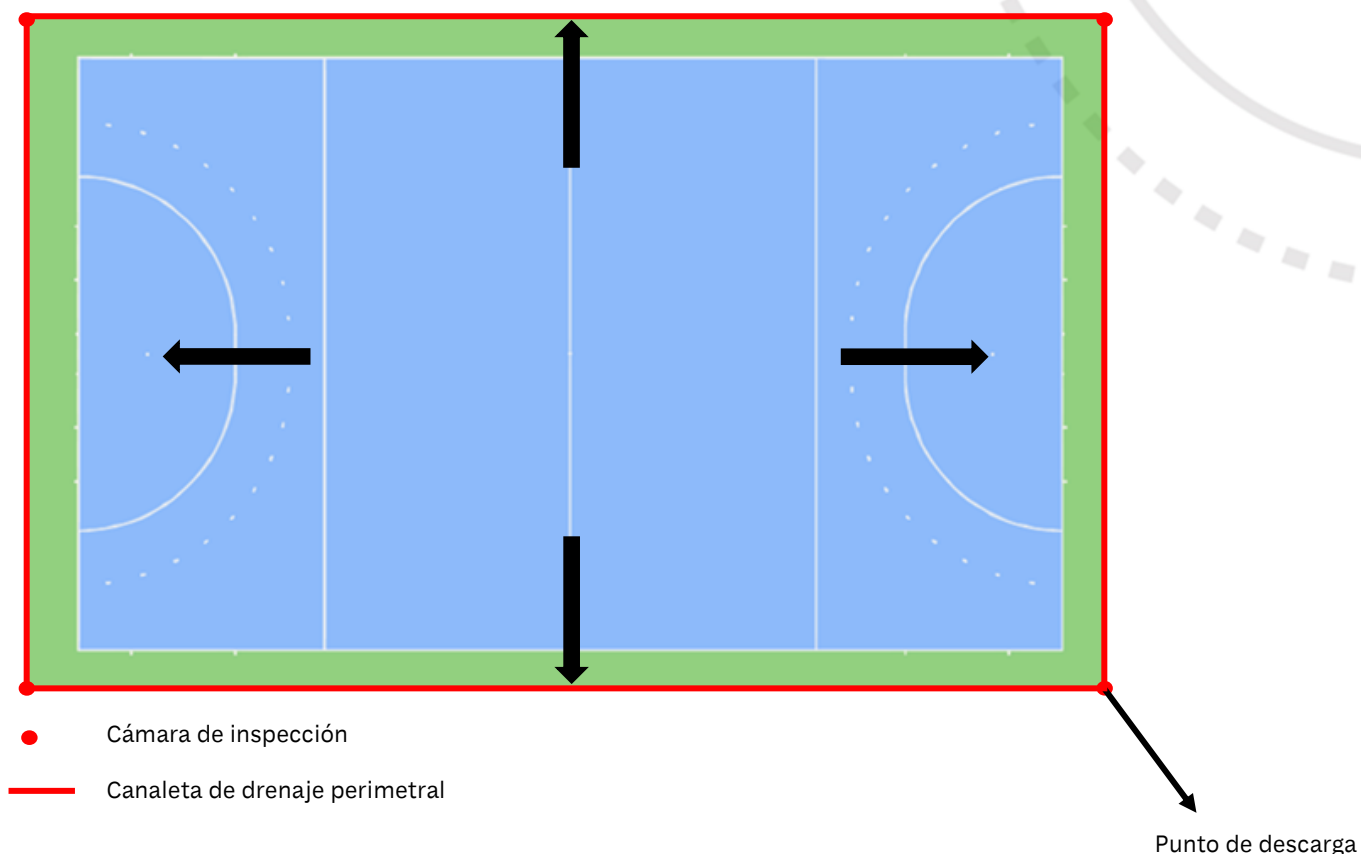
Sistema típico de drenaje del subcampo utilizado con la construcción de campos de drenaje horizontal.
